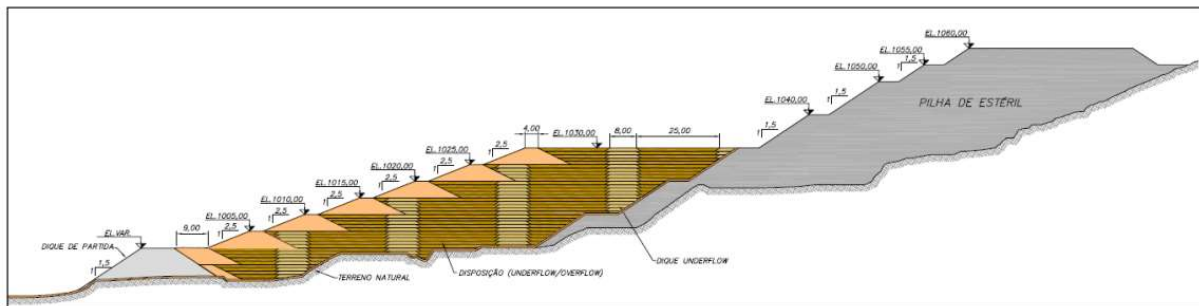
Disposição dos berços ao longo da elevação. Fonte: Mohallem, 2016.
